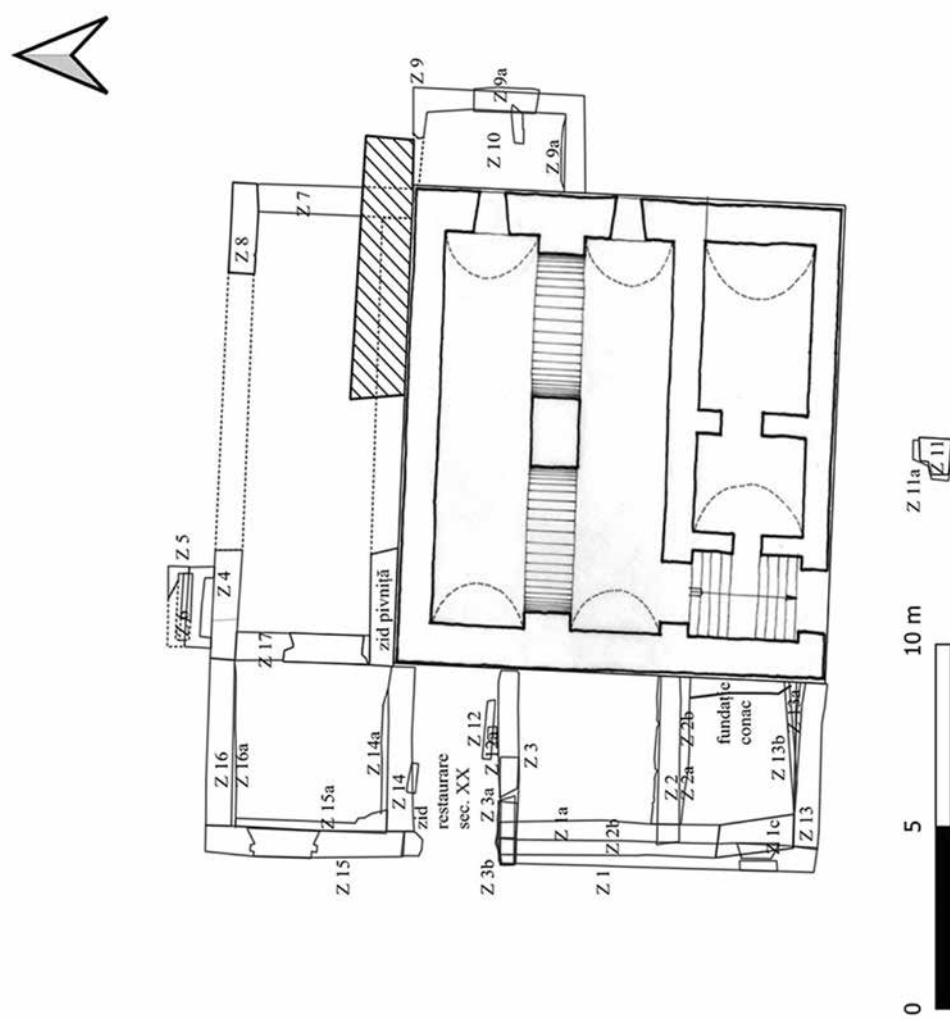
Mănăstirea Zamfira 2024, Conacul Zamfira: Plan general cu amplasarea structurilor constructive identificate
